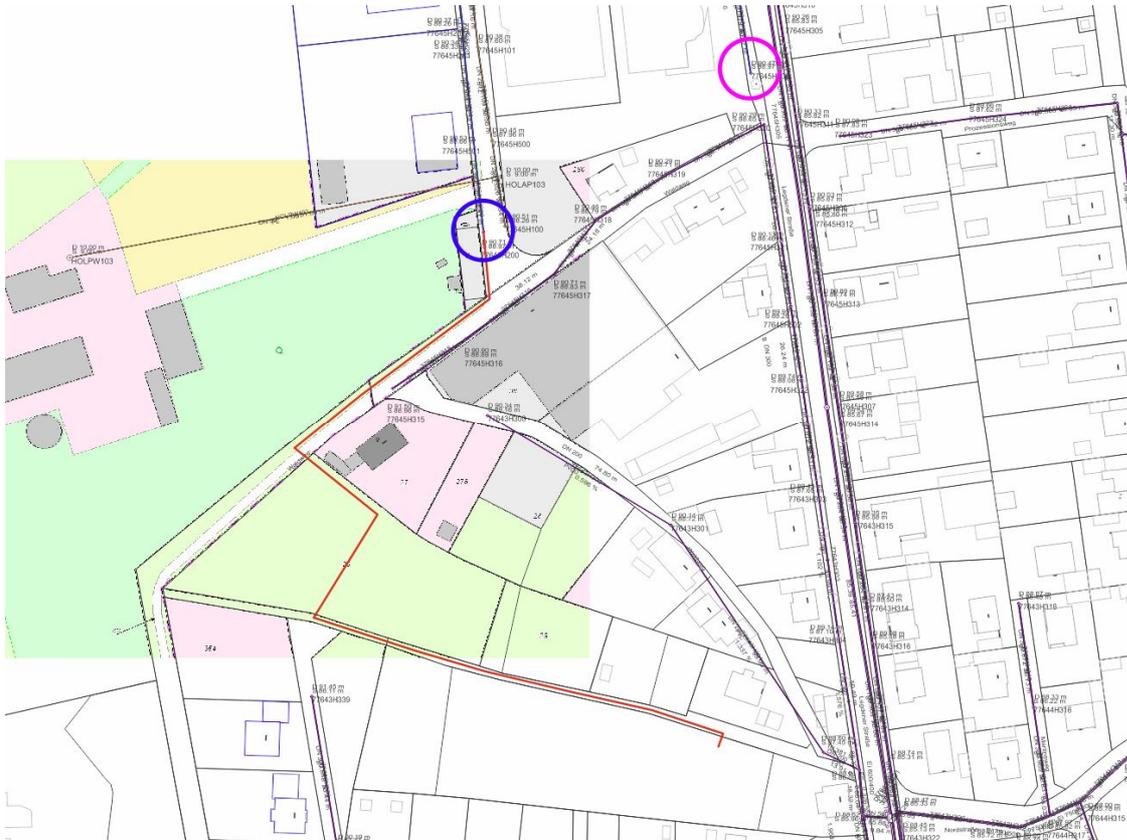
Rot die denkbare und kürzeste Druckleitungstrasse vom geplanten RRB mit Pumpwerk zur Handwerker Straße (blau); magenta die unwahrscheinliche Option mit Anbindung an die Straßenentwässerung der Legdener Straße
